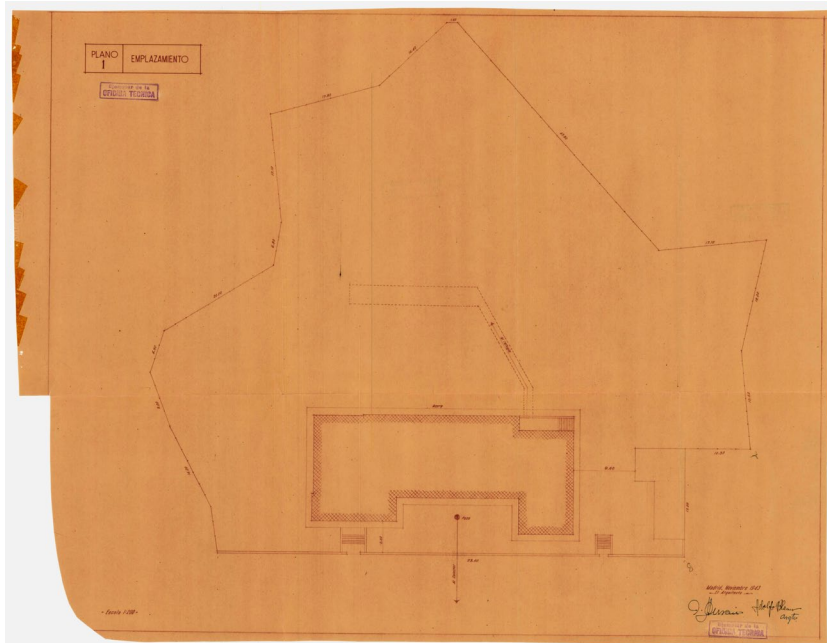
Grupo escolar en calle López de Hoyos (1943). Emplazamiento. Arquitectos: Adolfo López y Adolfo Blanco. AGA, Educación, 32/559.
